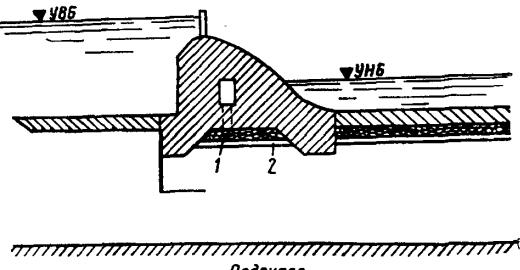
Горизонтальный дренаж под фундаментной плитой
